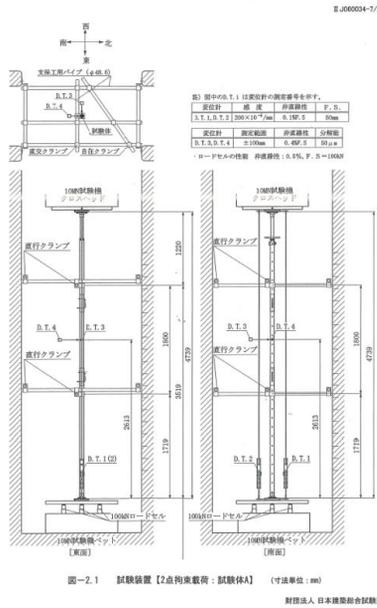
試験装置【2点拘束載荷: 試験体 A】 (寸法単位: mm)
